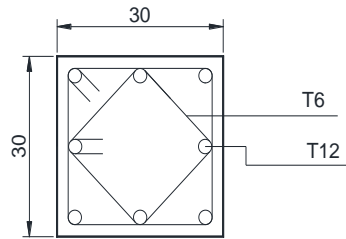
Ferrailage d'un poteau 30x30cm (poutres normales - plancher au dalles pleines)
